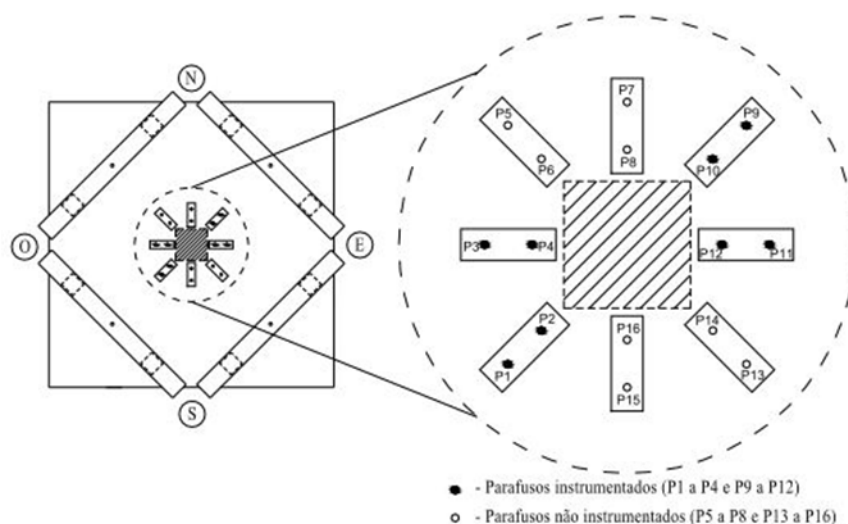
Vista em planta da geometria de reforço dos modelos ensaiados por Duarte.
